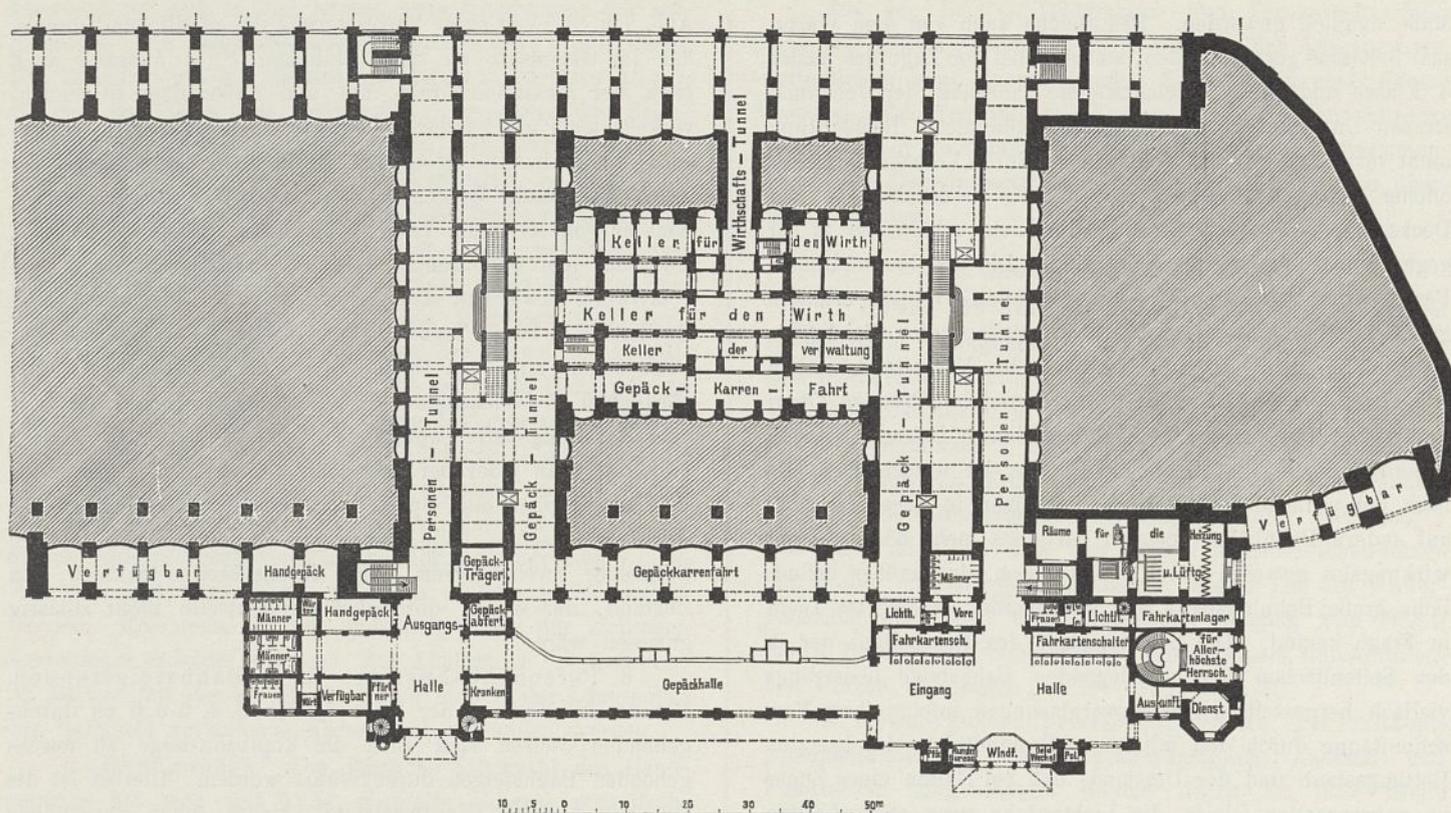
Hauptbahnhof. Erdgeschoß vor dem Umbau.
